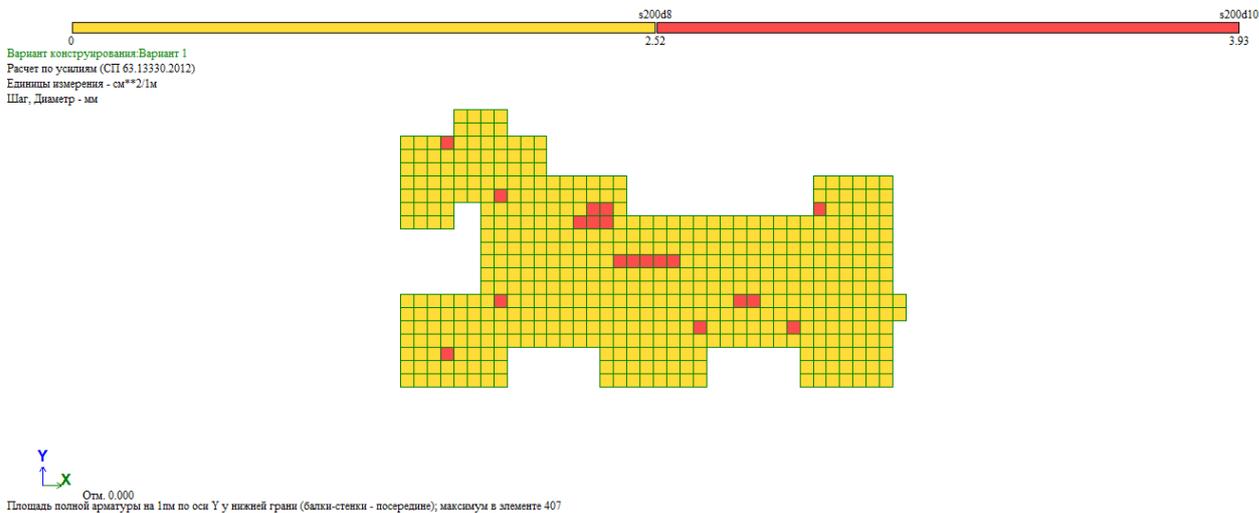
Подбор нижней поперечной арматуры по оси Y
